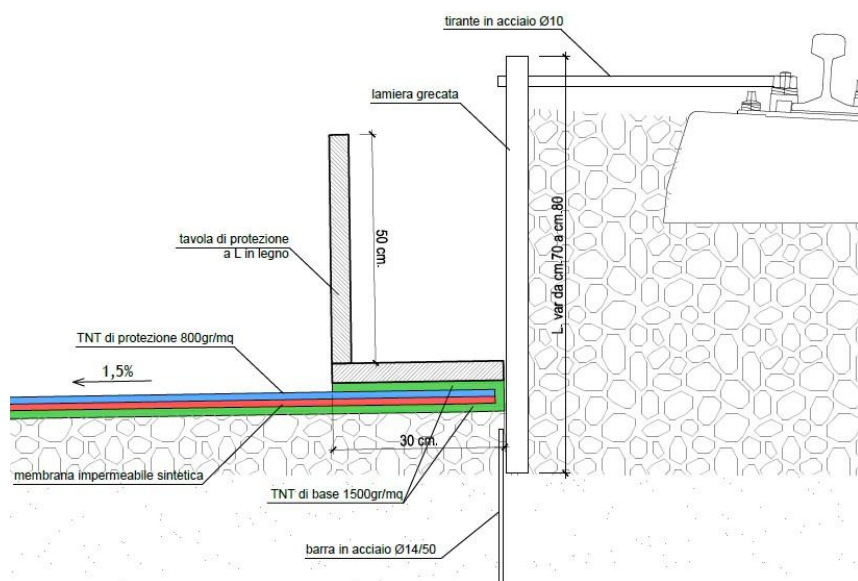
b - Protezione della giunzione longitudinale
